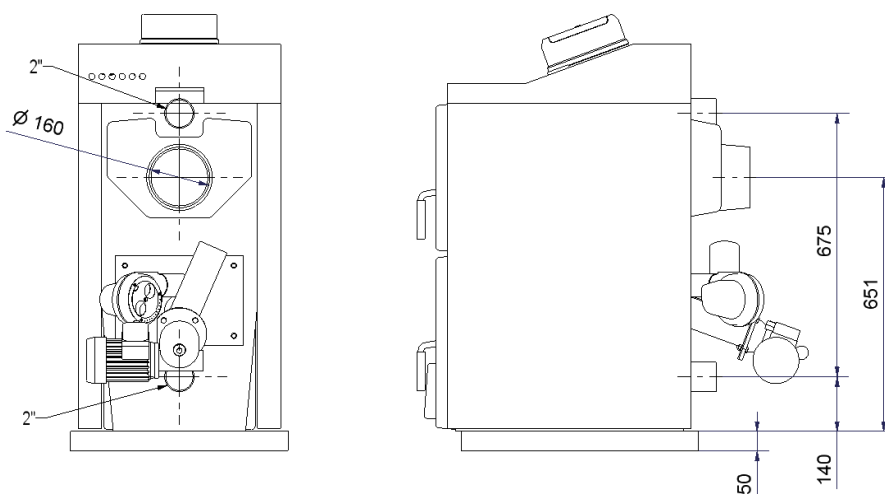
Присоединительные размеры котла VIADRUS HERCULES ECO
